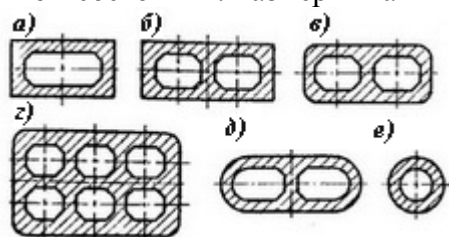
Формы опускных колодцев в плане: а — прямоугольная; б — прямоугольная с внутренней стеной; в, г — прямоугольные с закруглениями в углах; д — вытянутая с короткими сторонами в виде полуокружности; е — круглая.
